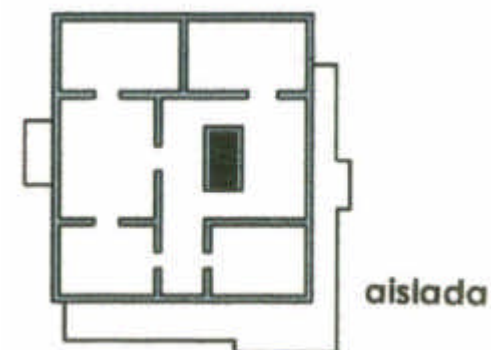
ESQUEMA DE LA CASA AISLADA. Con el perímetro libre, rodeado de jardín.
